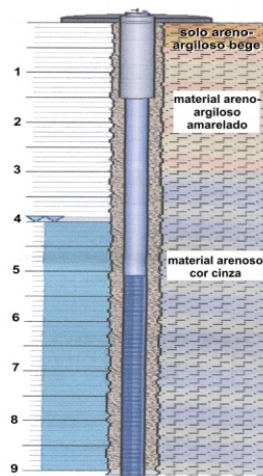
Perfil do piezômetro da Barragem do Clóvis montante
